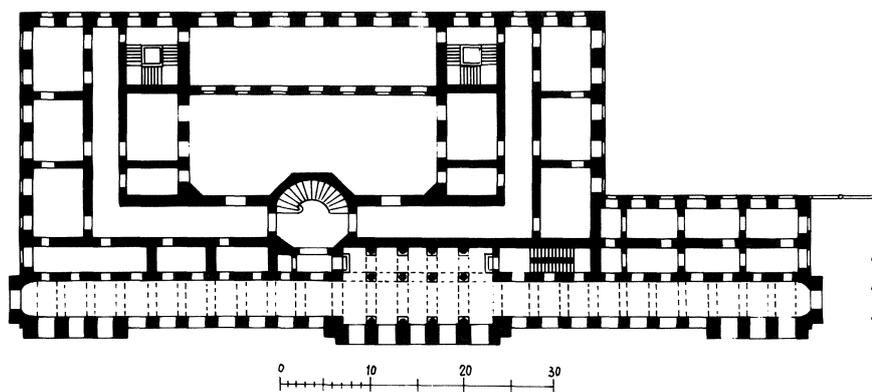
Planta baja del Seminario-Consistorio de Santiago.
